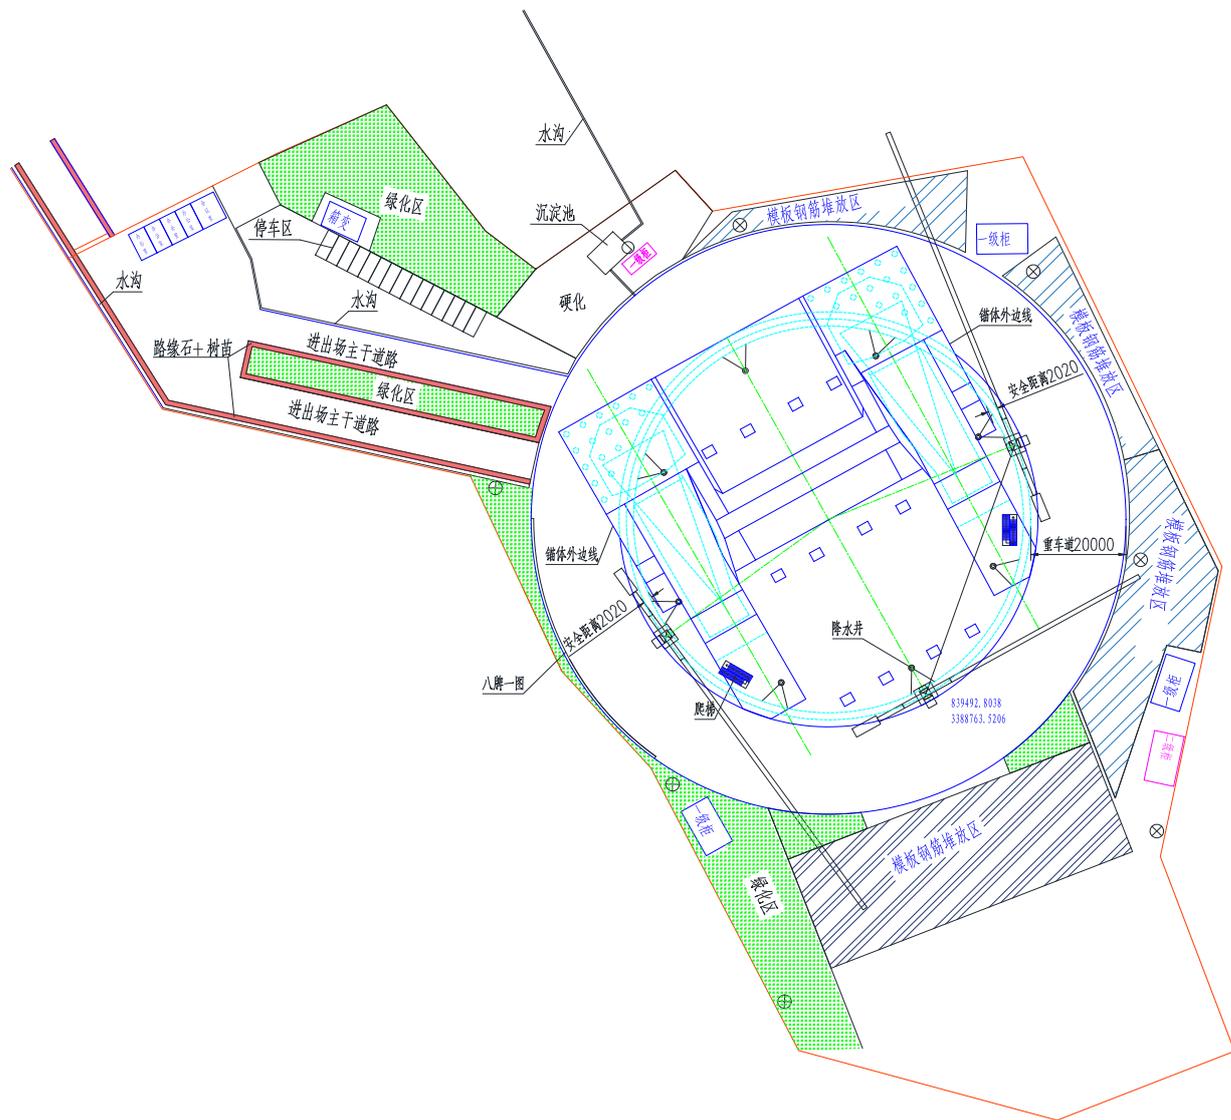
设备与建筑物平面安全距离（mm）
